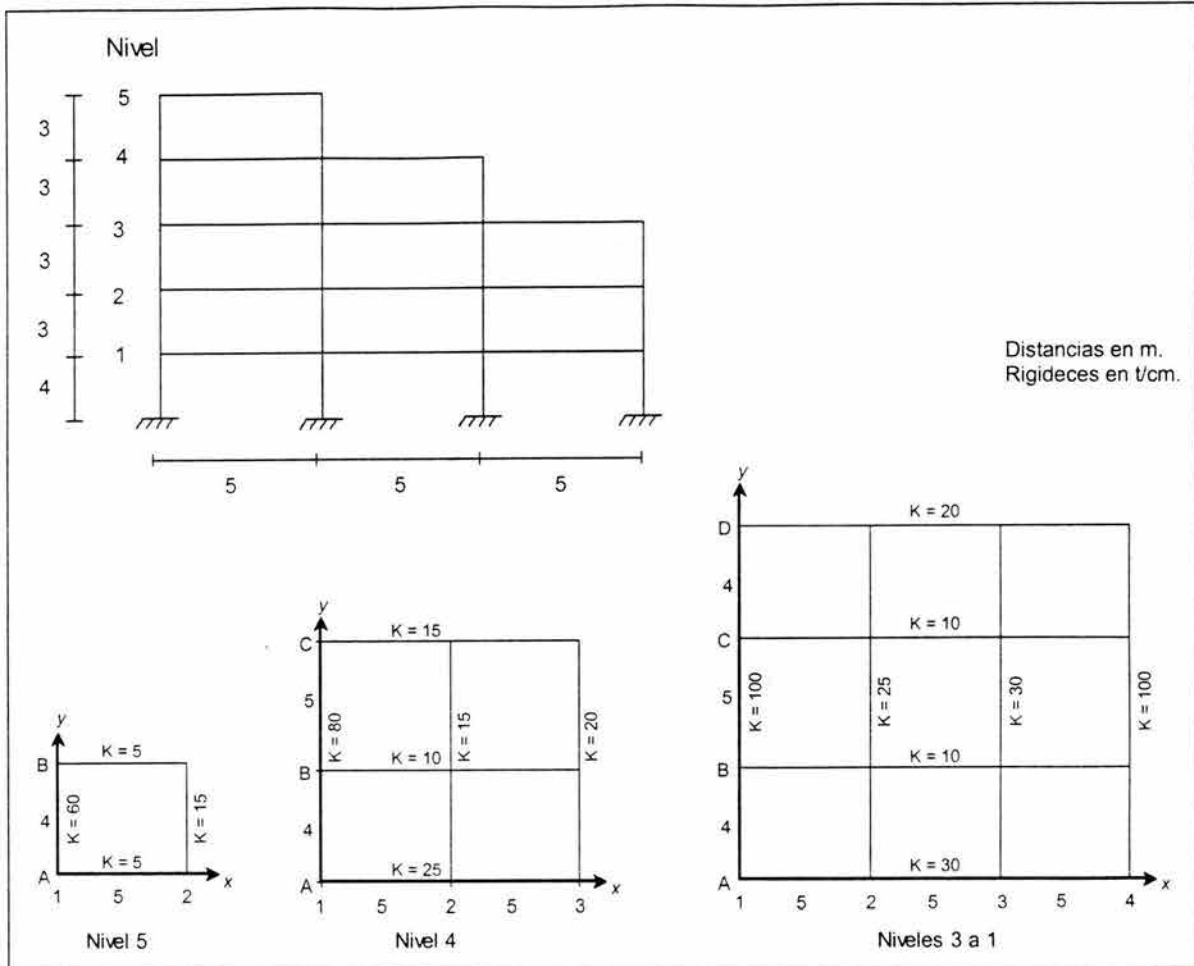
Elevación y planta del edificio del ejemplo 1.
